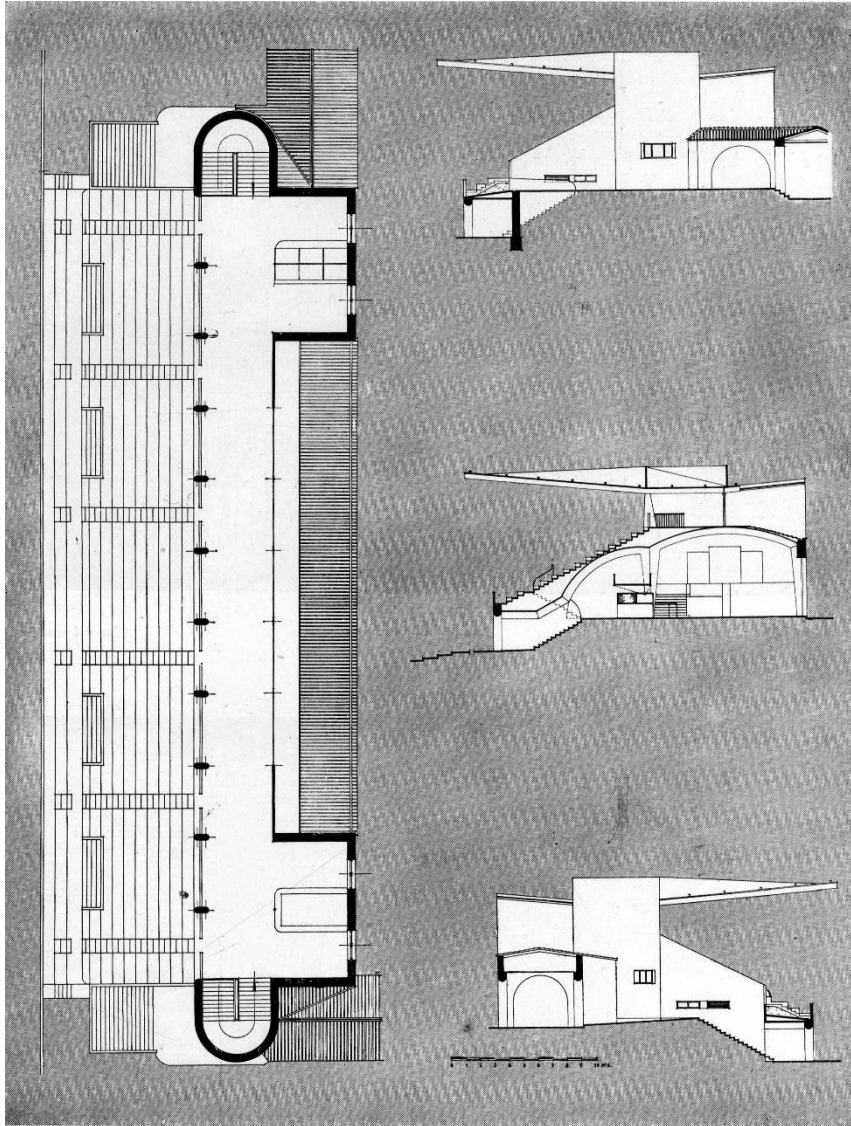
Planta alta y secciones de la tribuna de preferencia presentadas al concurso. (Fuente: Revista Nacional de Arquitectura, nº 81, 1948)
